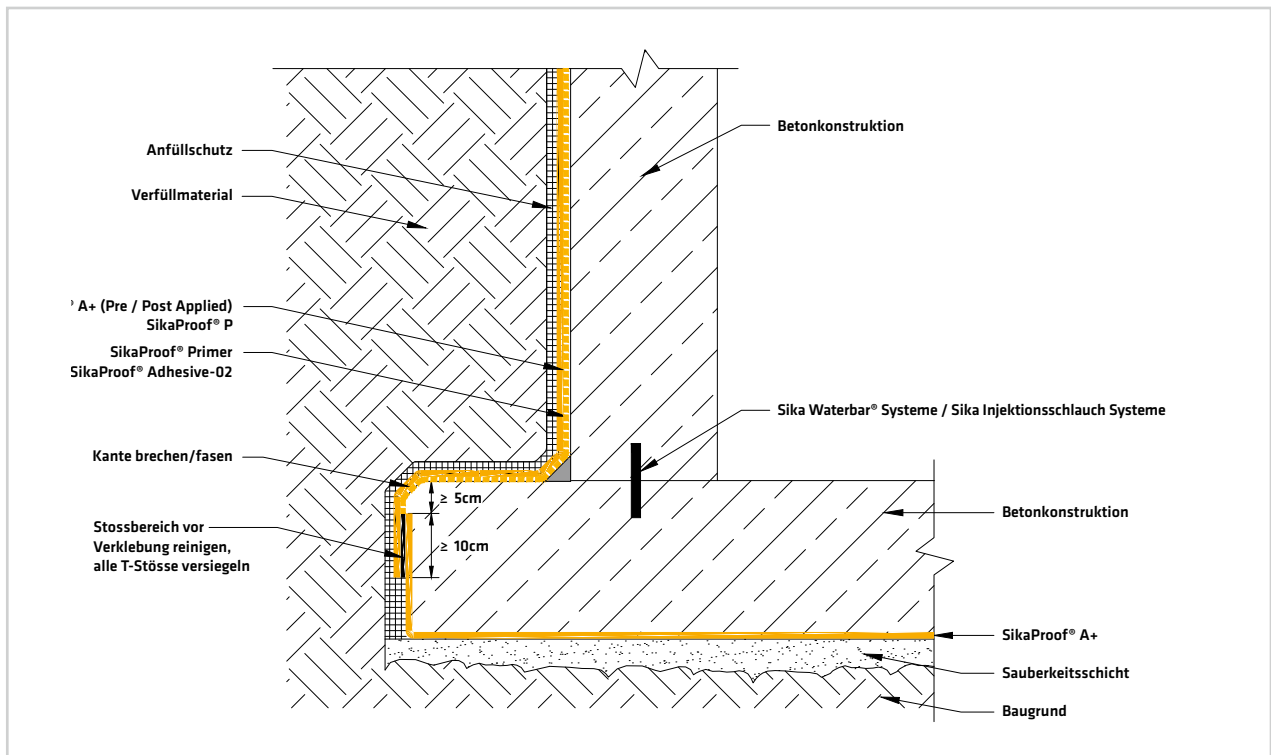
Arbeitsfuge Boden-Wand ohne Überstand mit Anschluss zu SikaProof® P
